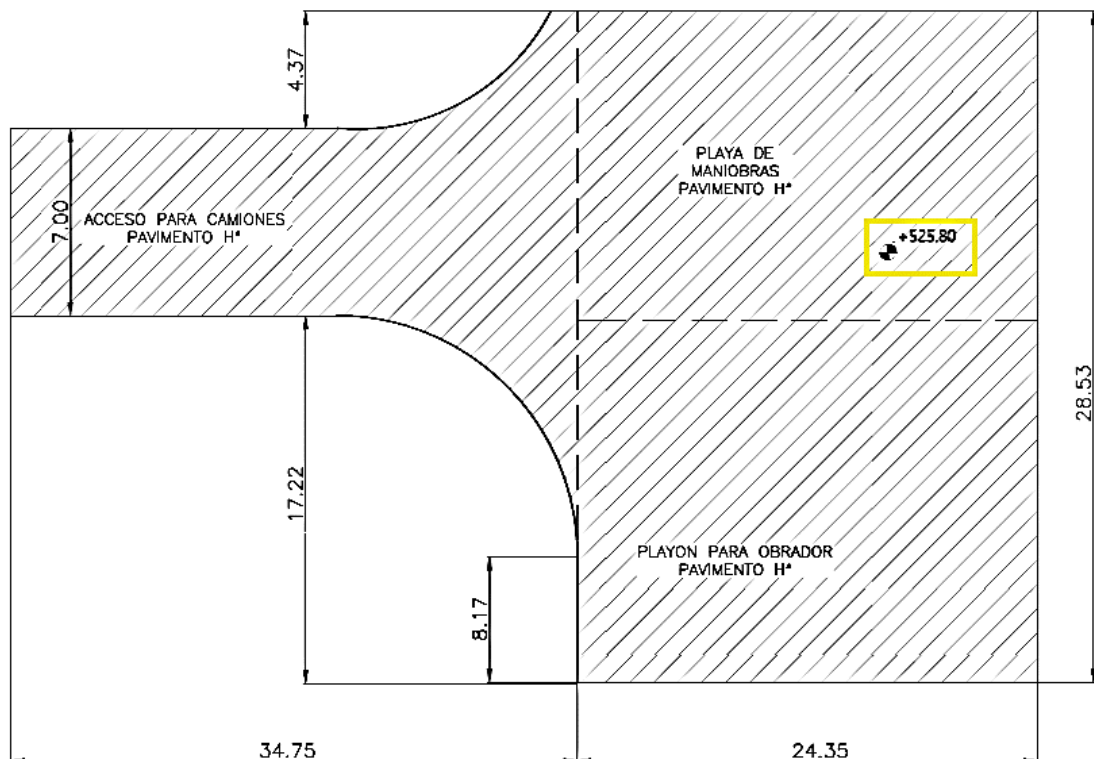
Excavaciones bajo pavimentos o pisos
